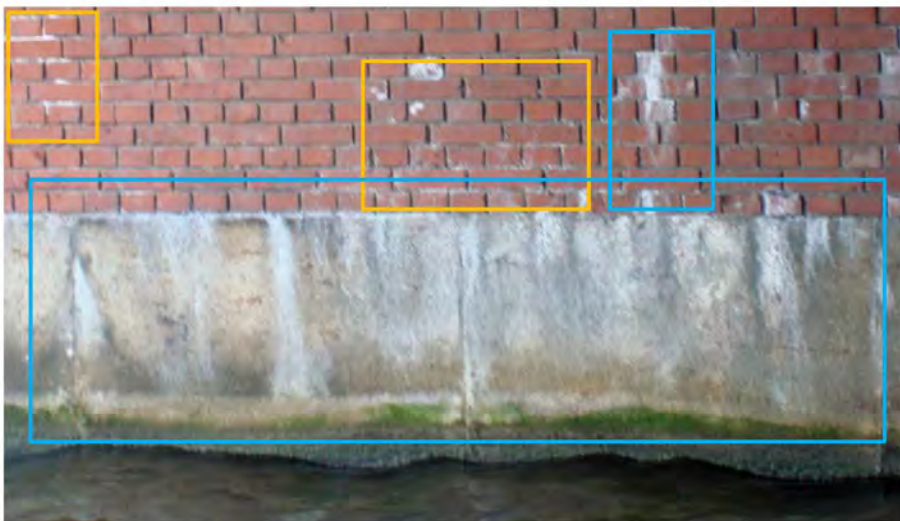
calcietuitbloeiingen t.p.v. plint (blauw) en zoutuitbloeiingen (geel).
